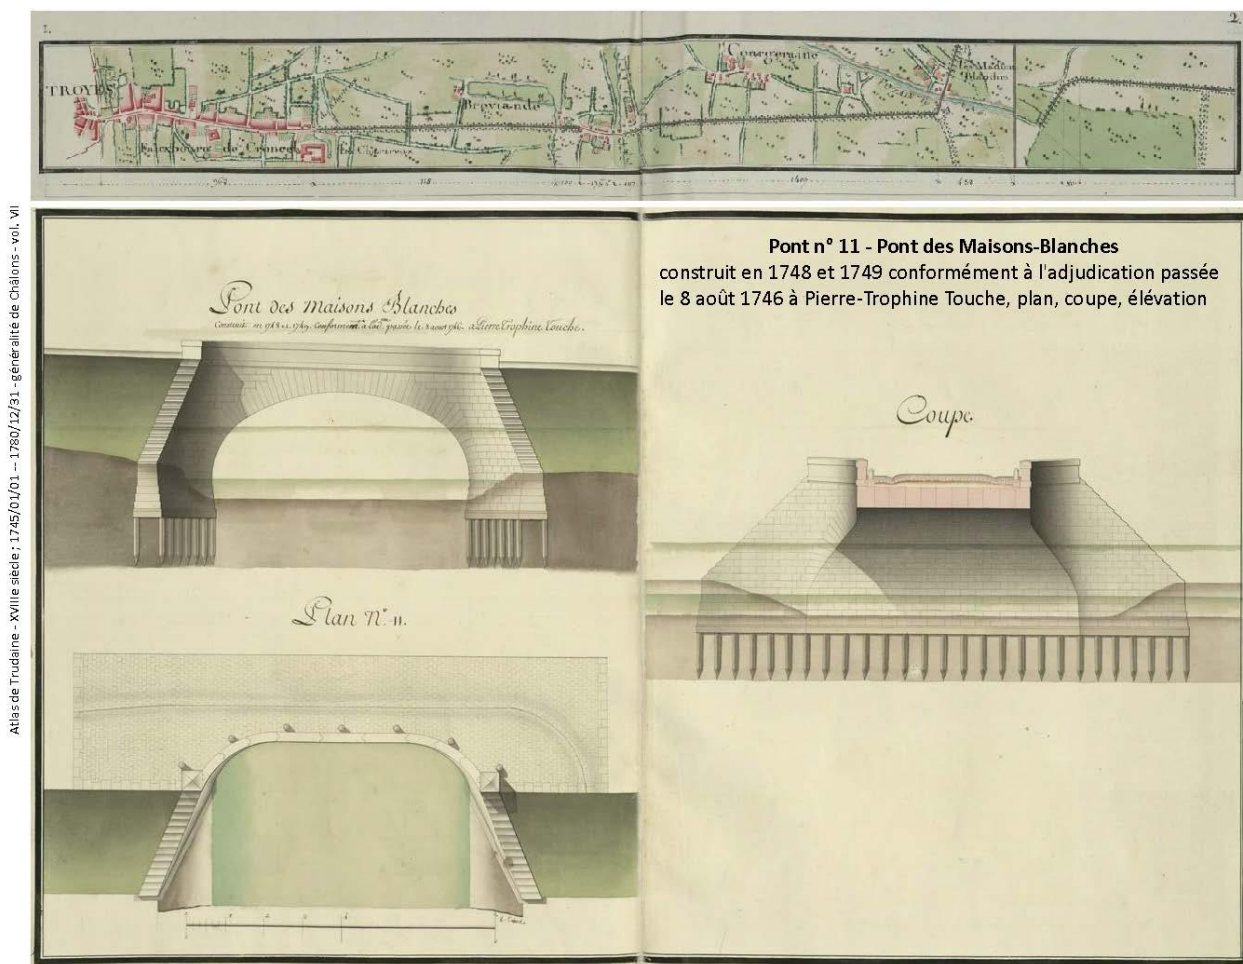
Pont des Maisons-Blanches (plan, coupe, élévation) – Source : Atlas de Trudaine
